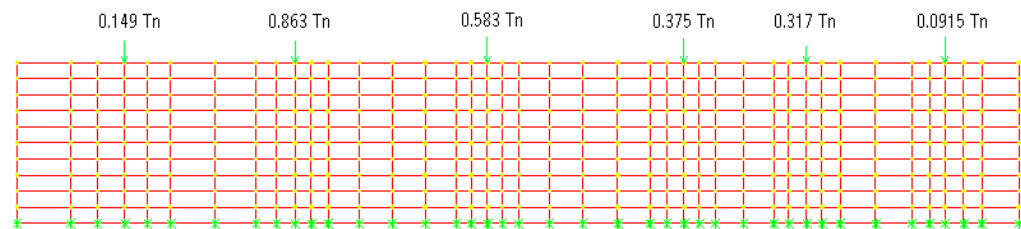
Carga viva producido por las vigas sobre el muro.
